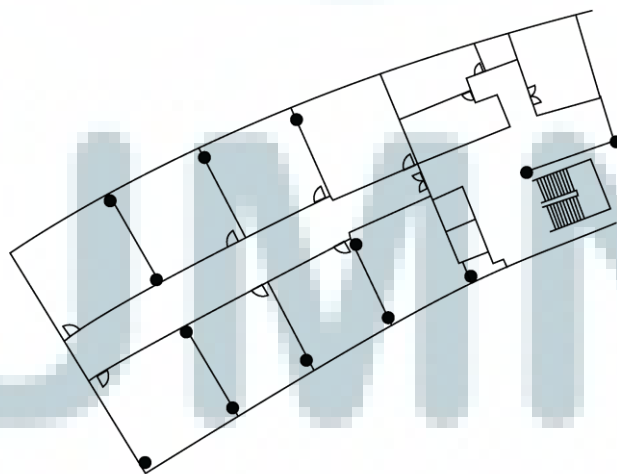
Denah Lantai 3 Yang Sudah Disederhanakan Setelah Diimport Ke 3DS Max
